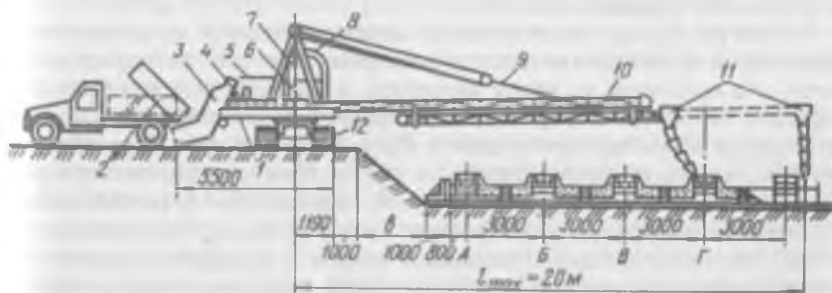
Бетонирование железобетонных фундаментов с применением ленточных бетоноукладчиков:
